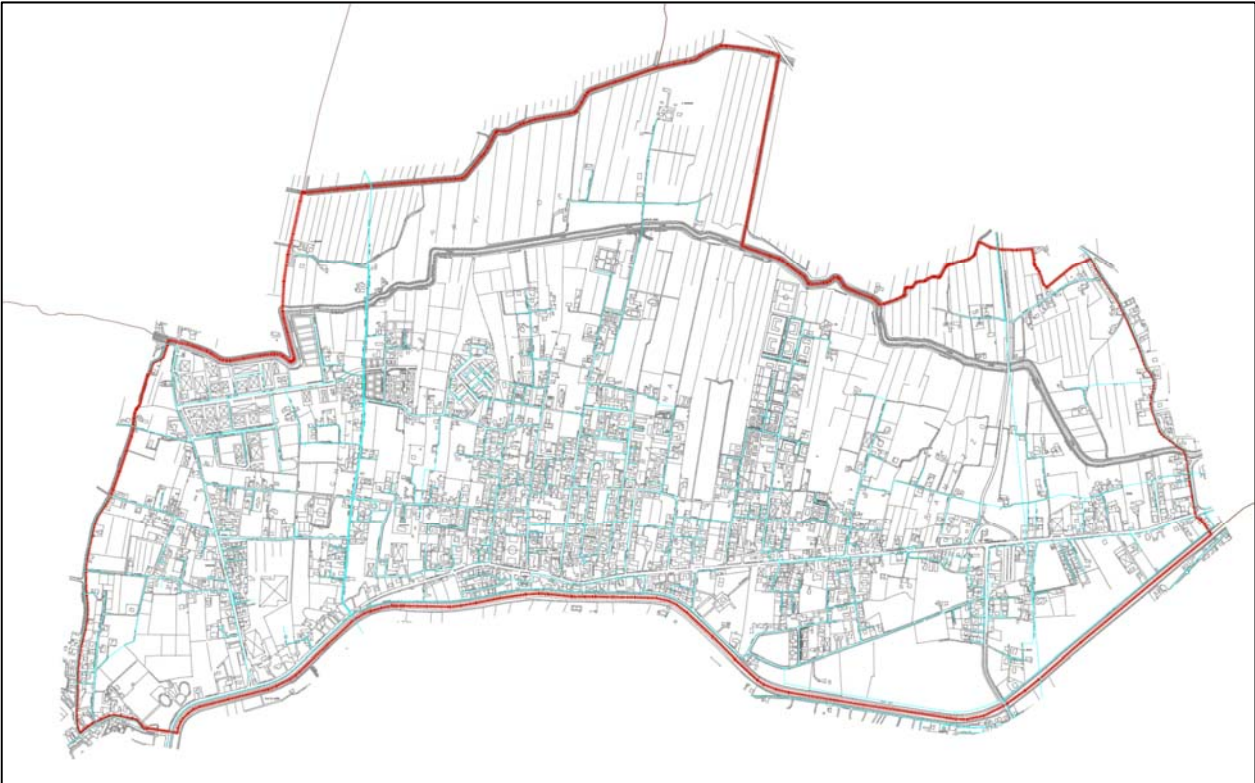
Planimetria della rete idriche – Fonte VERITAS 2018
